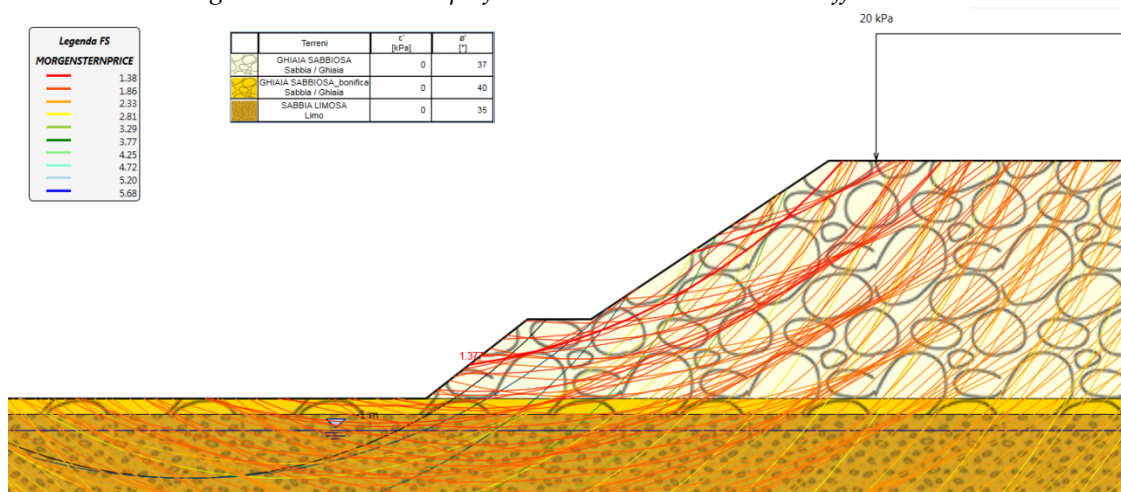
Dettaglio piede rilevato con la superficie di scorrimento con F_s minimo ($F_{smin}=1.377$)
